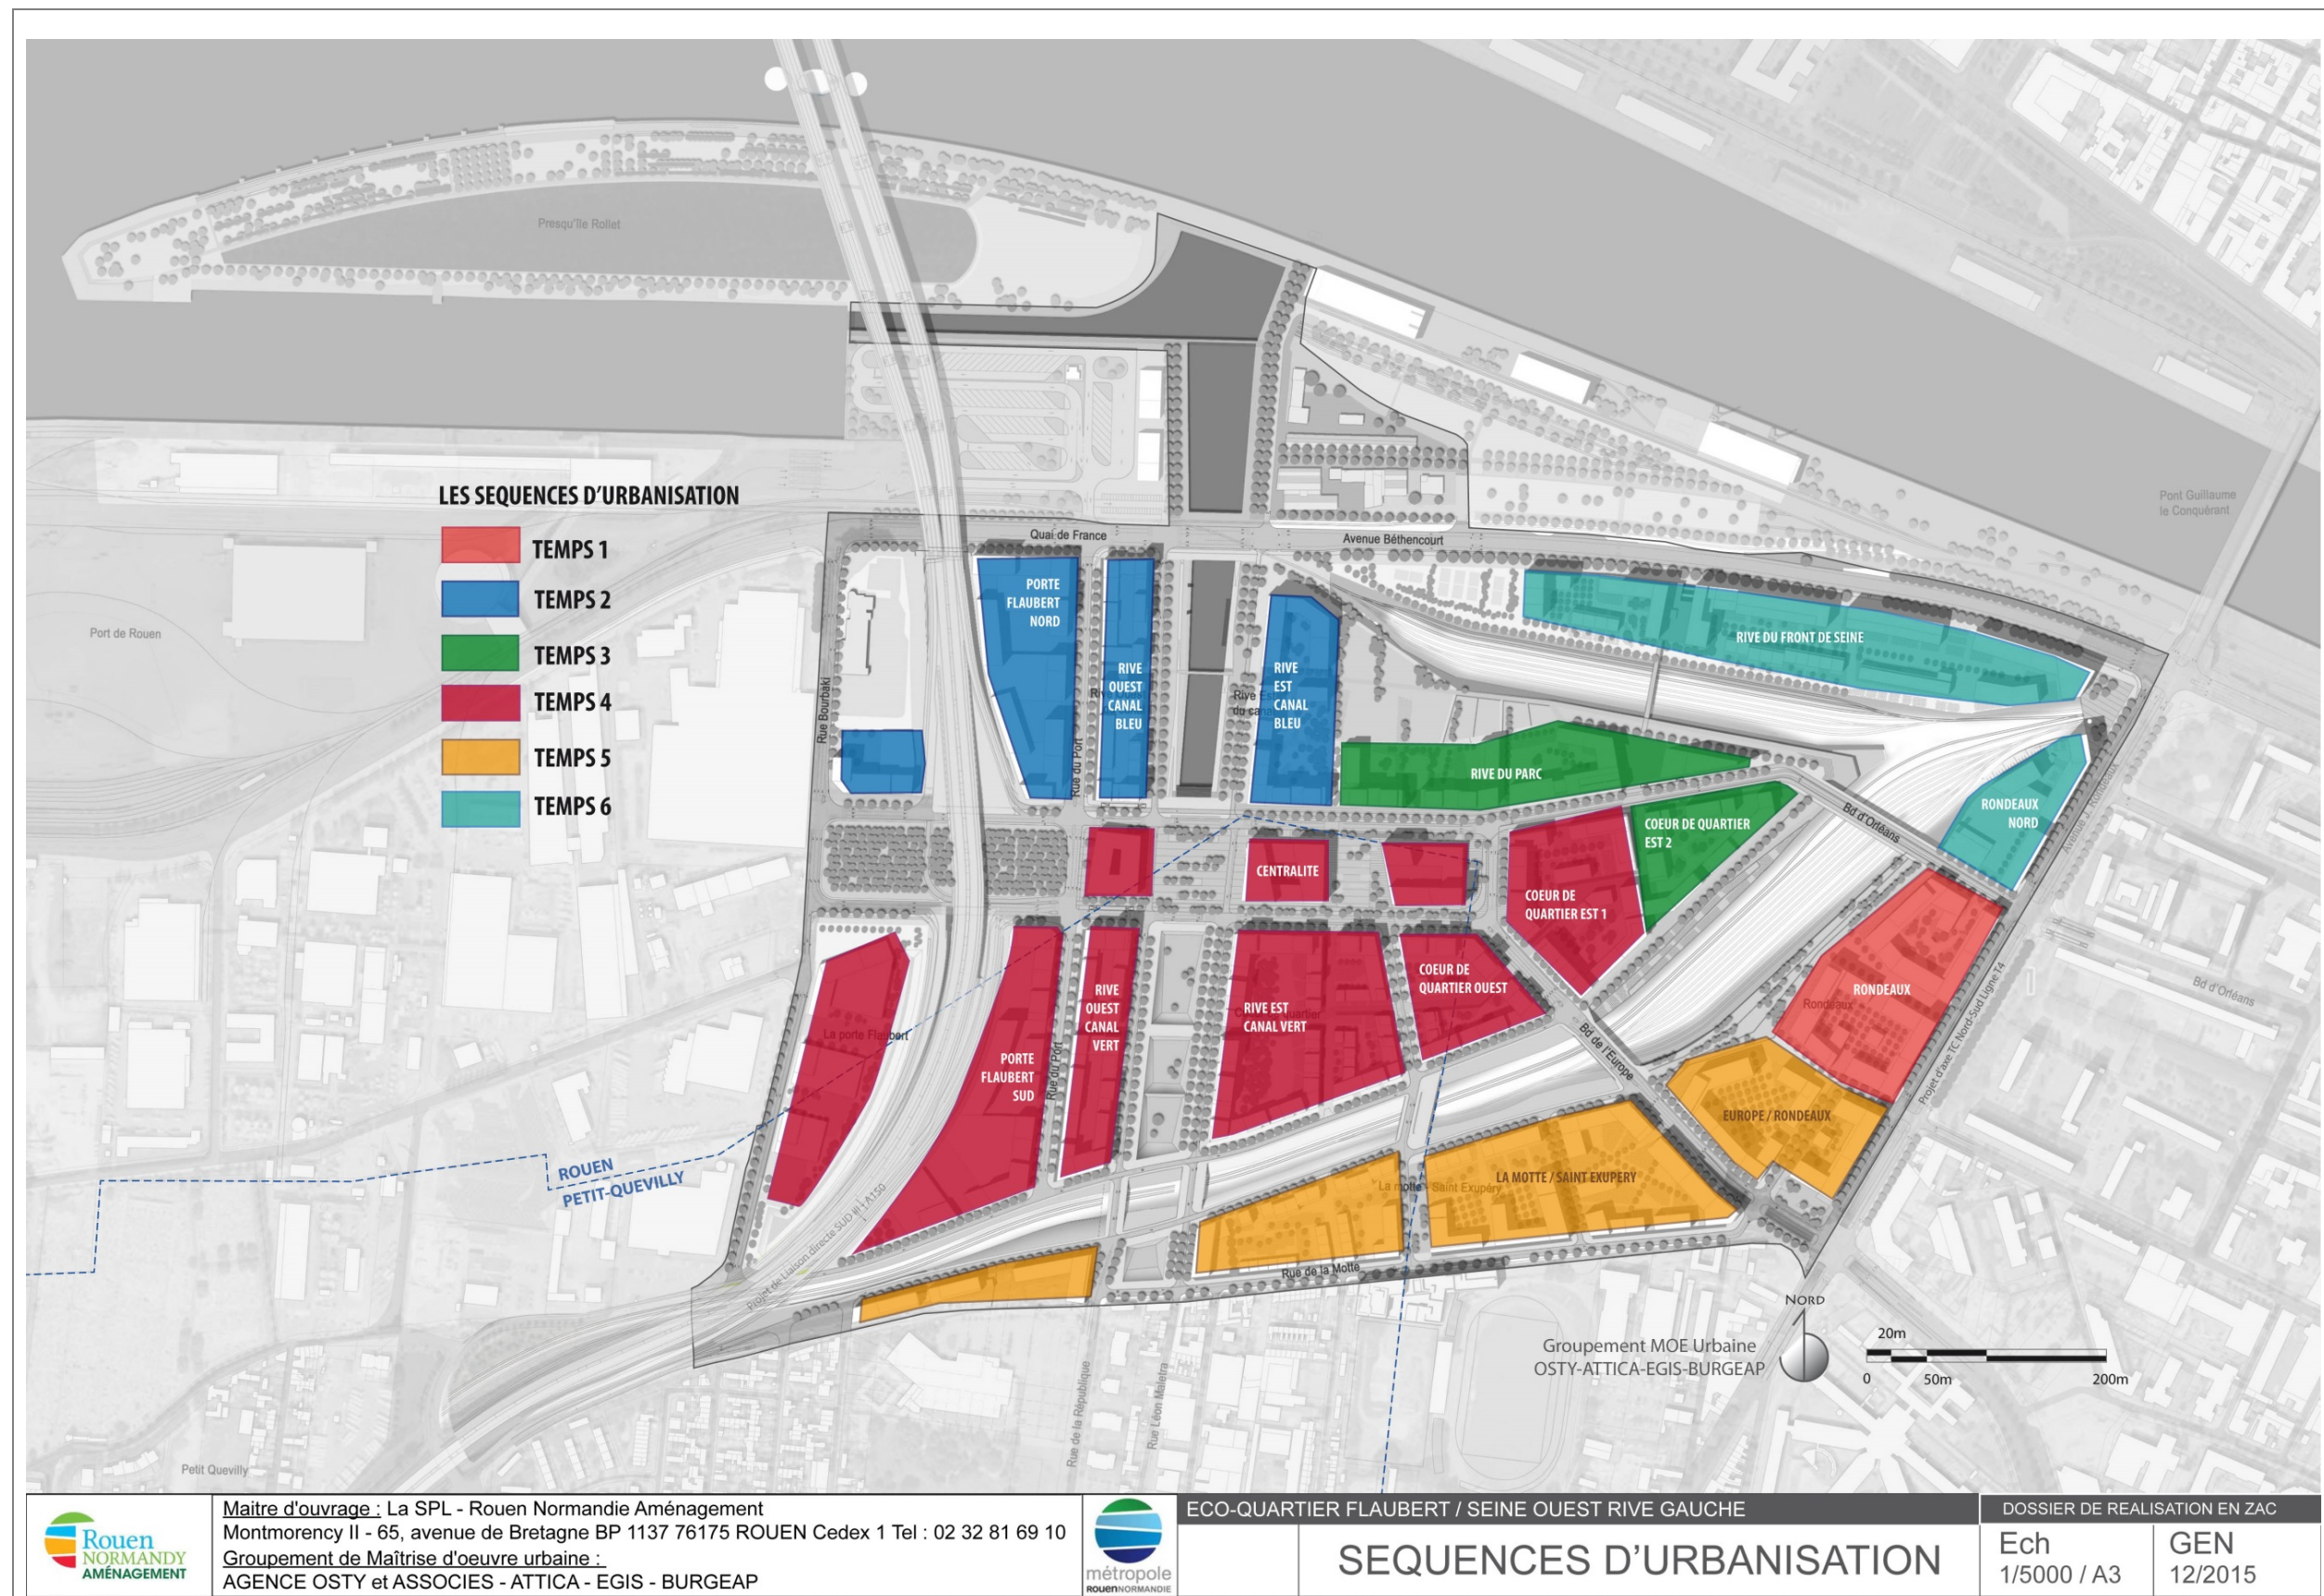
Plan des séquences prévisionnelles d'urbanisation au stade de la réalisation sur plan masse indicatif [MOE urbaine, 2015]
